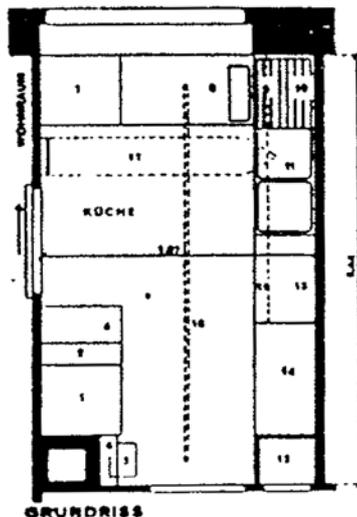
Grundriss der Frankfurter Küche (l)
